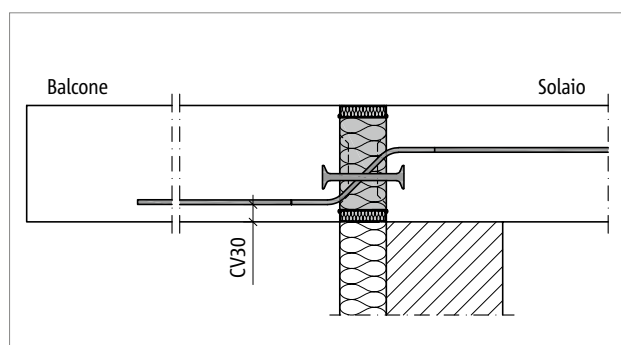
Schöck Isokorb® T tipo Q-P-CV30: sezione
